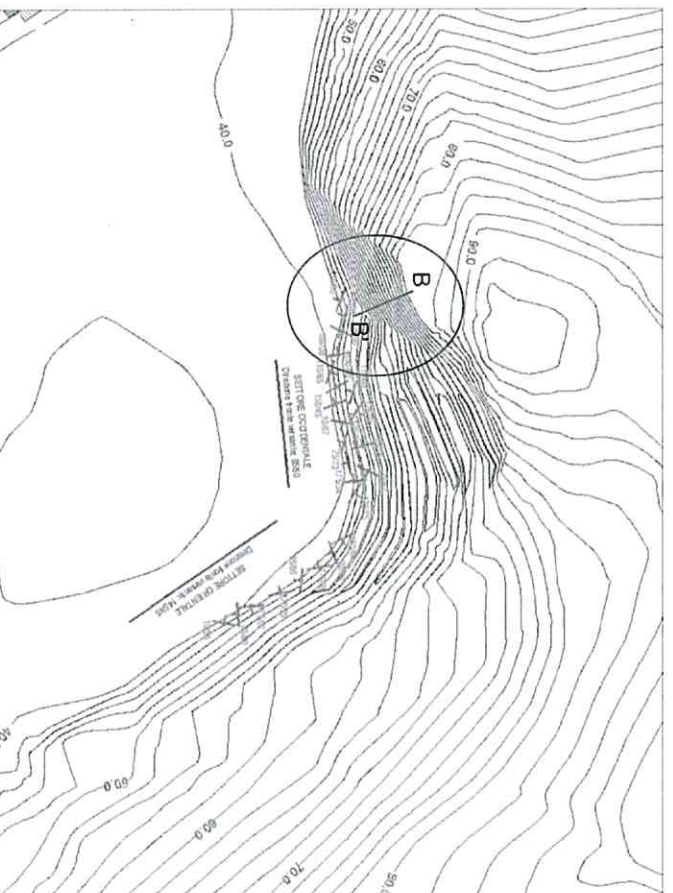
Planimetria con ubicazione della traccia della sezione di verifica
